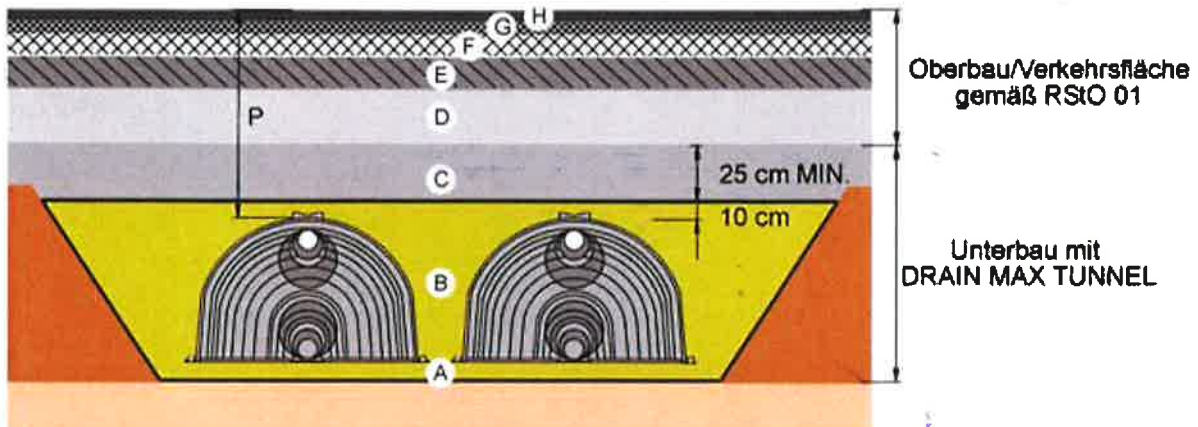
Beispiel für Unterbau / Oberbau mit bituminöser Decke gemäss RStO 01, Bauklasse V, Zeile 3.1
